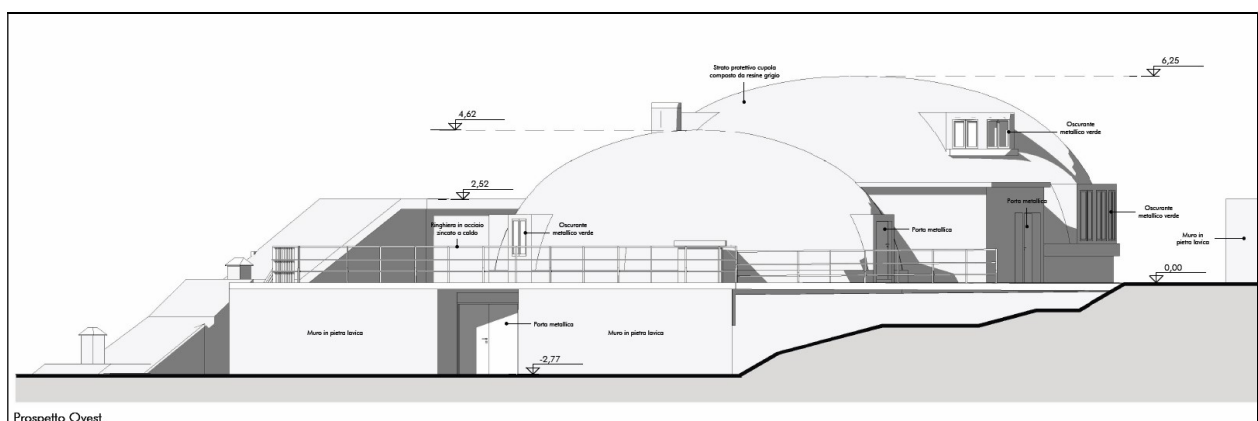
Prospetto Ovest - Stato di fatto (fonte Progetto - AIACE)
